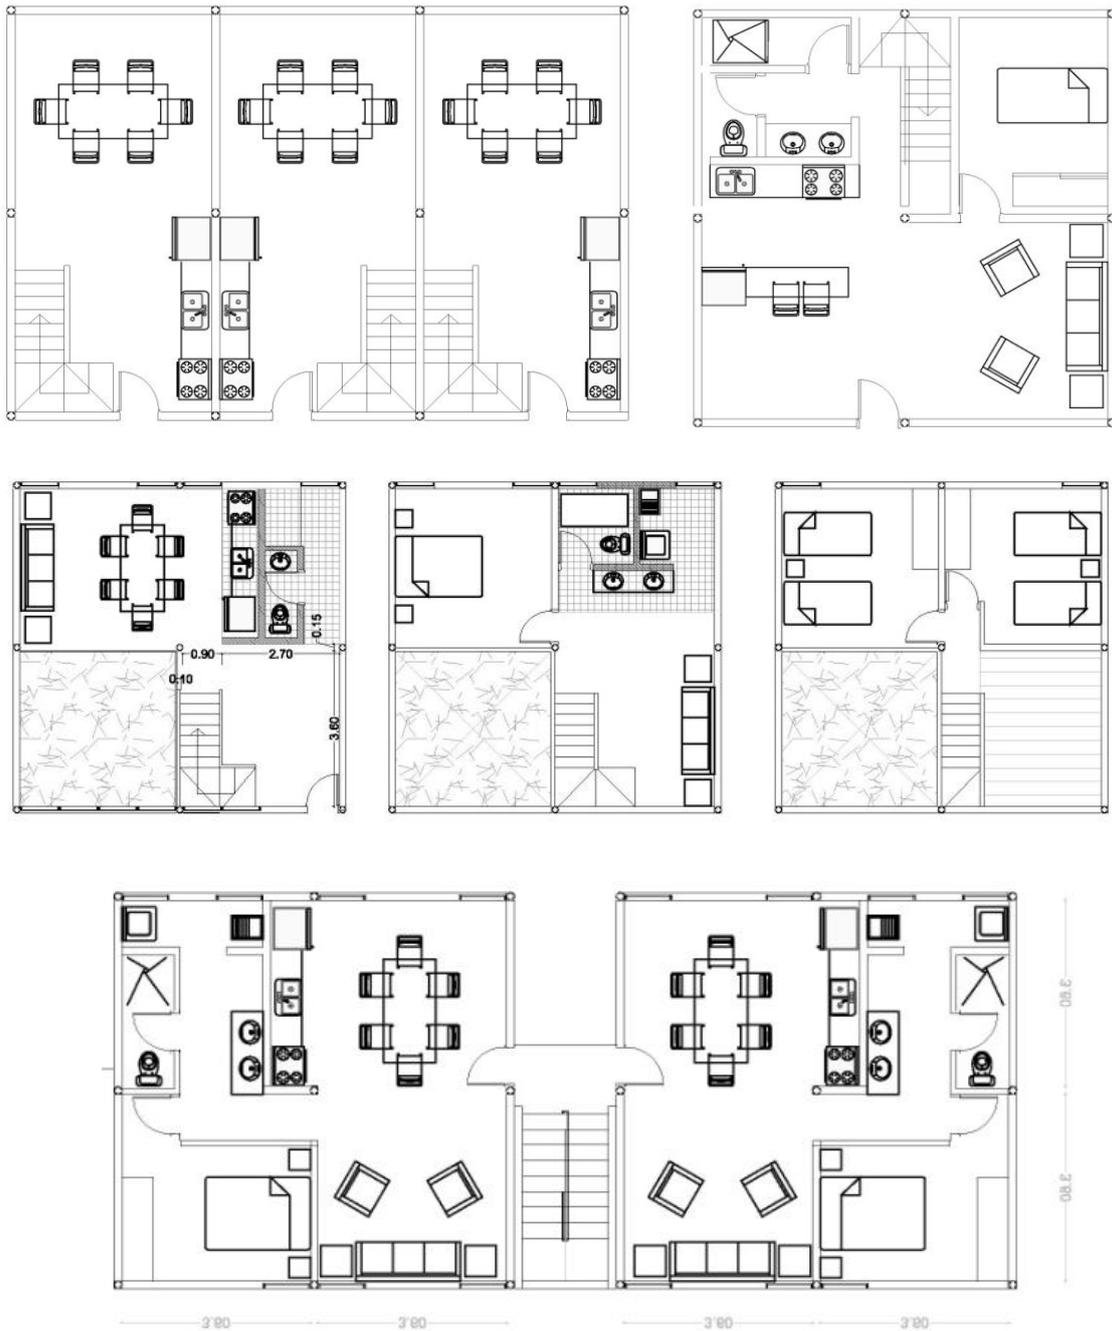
Esquemas iniciales en planta con dos y cuatro módulos.
